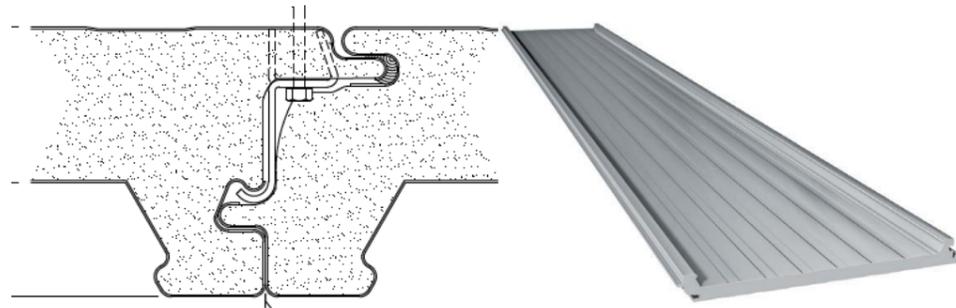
Paneles sándwich con sistema de colocación machihembrado
